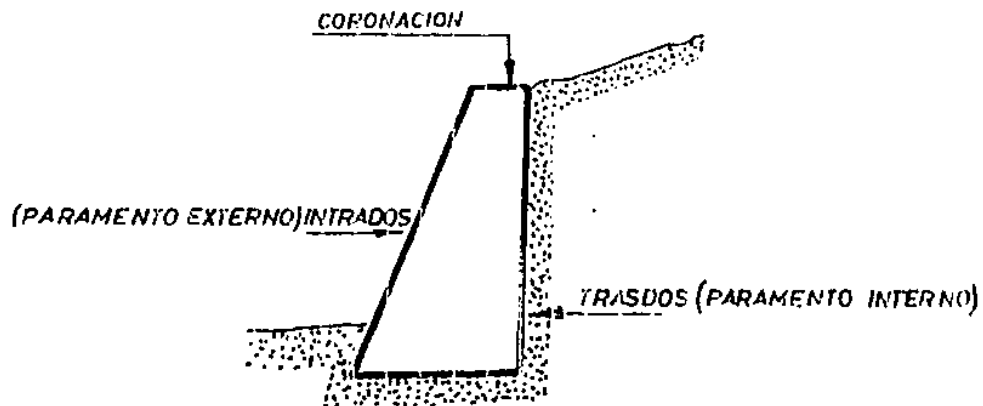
Muro de concreto en masa o mampostería (Barros; 1974: 13)
